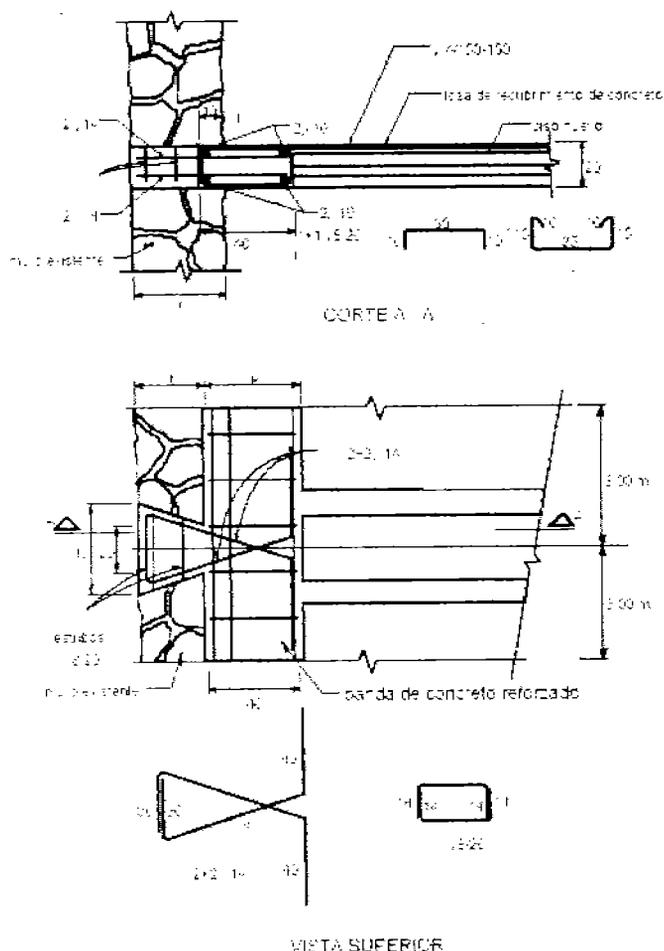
CONEXIÓN DEL NUEVO REFUERZO DE LA LOSA A LOS MUROS DE CARGA.
